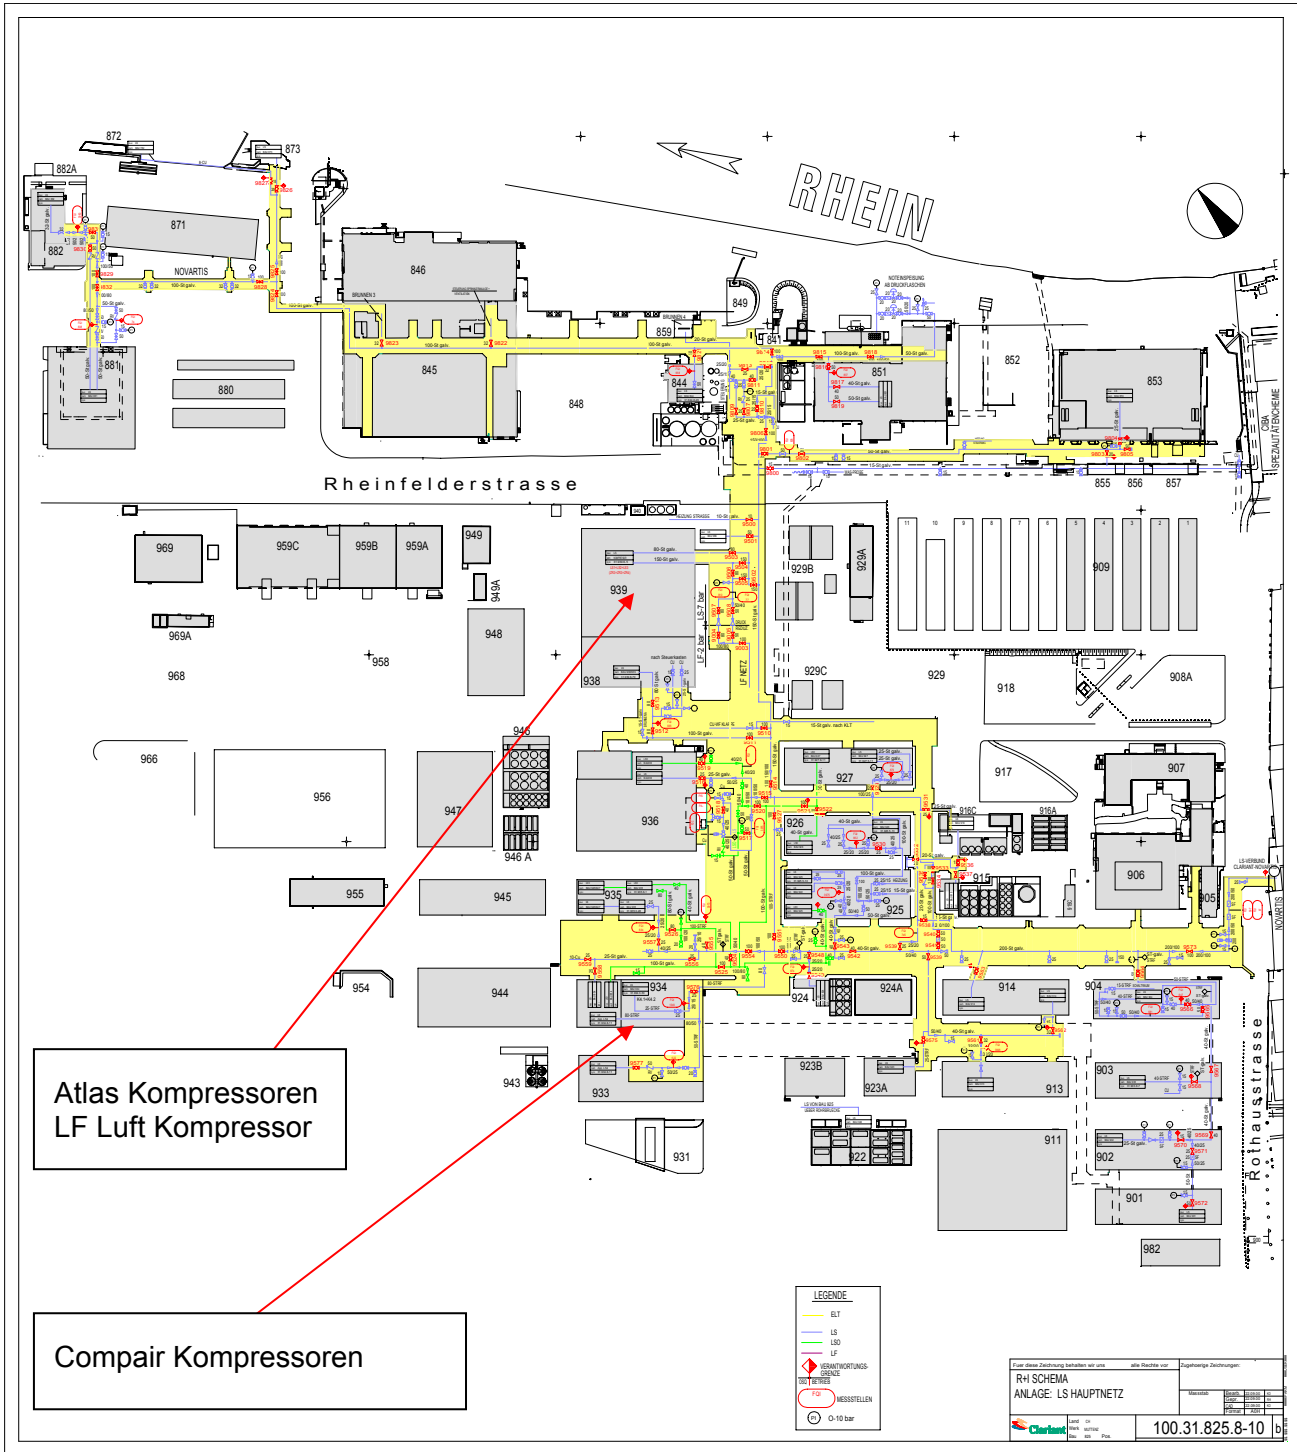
Lageplan mit Lage der Druckluftverteilung
